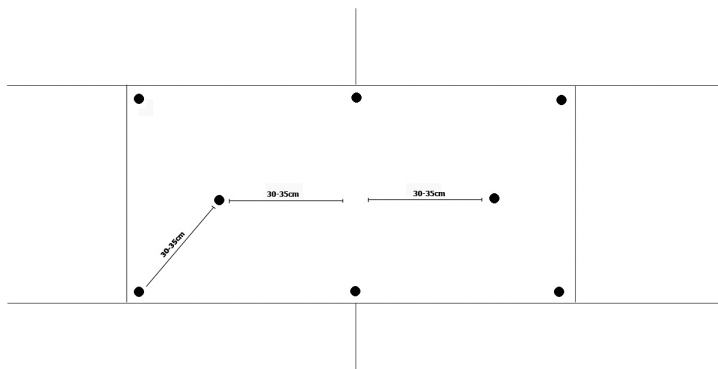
Esquema de aplicação das buchas no sistema CANDIWALL
